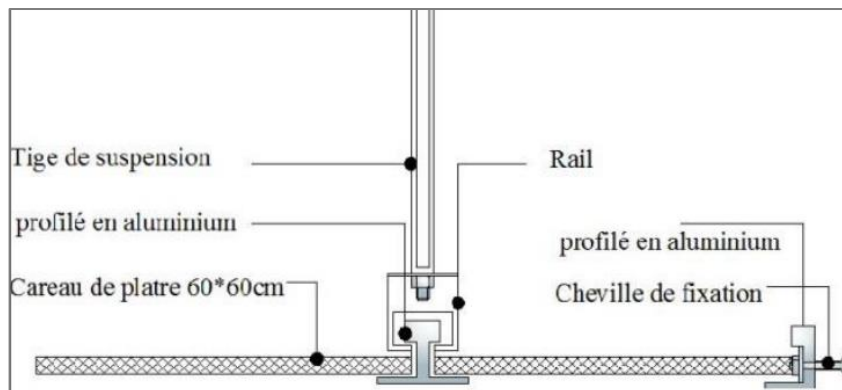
détail de fixation des faux plafond (coupe 1/20)
